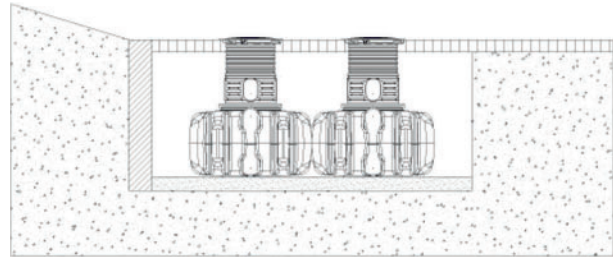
Installation sur terrain en pente – Exemple FLAT
